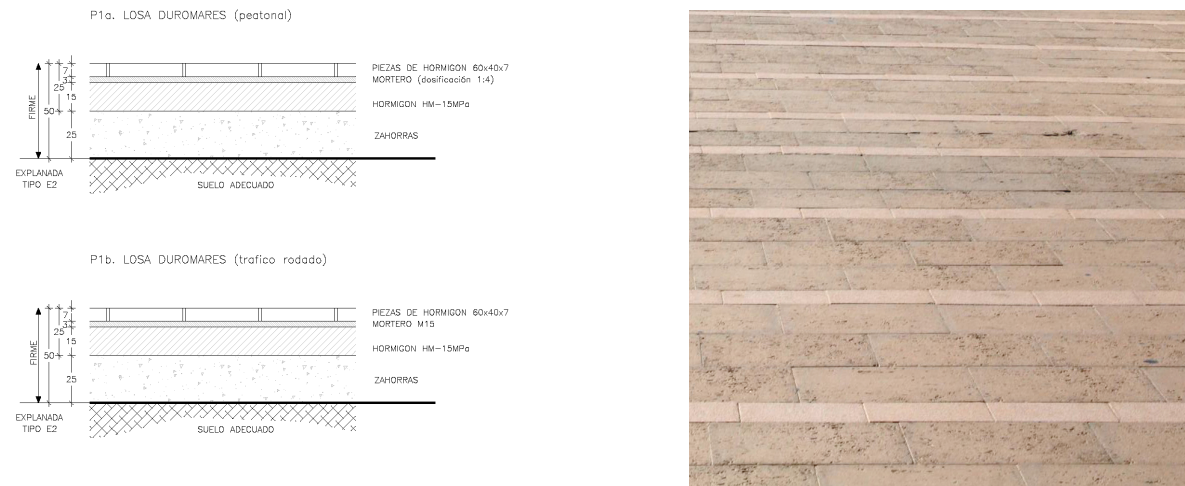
Secciones constructivas del pavimento P1 e imagen de referencia.
